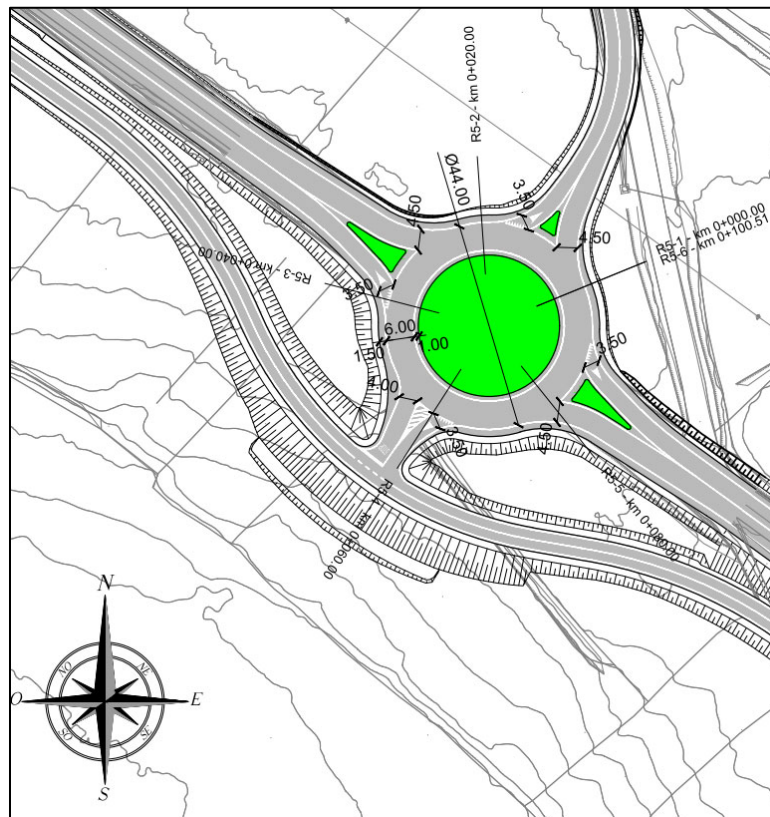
Estratto della planimetria di progetto della rotatoria 5
